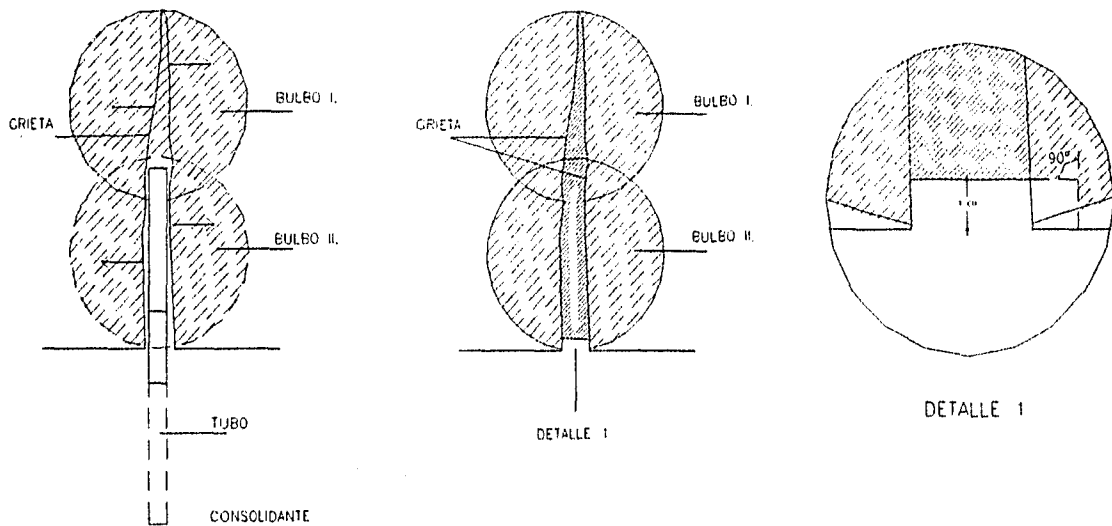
SISTEMA DE CONSOLIDACION DE GRIETAS
